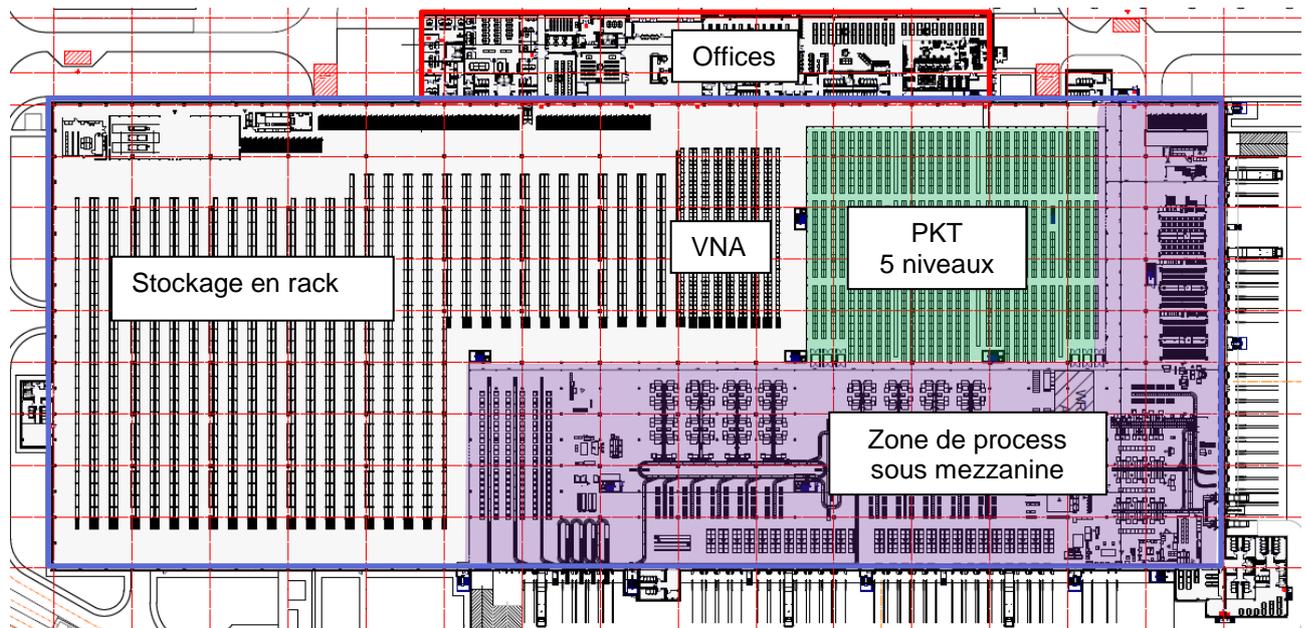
Plan du niveau RDC – P1 (+0,00 m)
